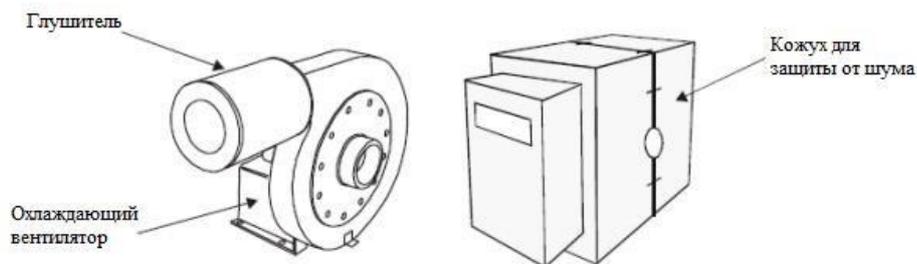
Охлаждающий вентилятор, дополнительный глушитель и кожух для защиты от шума
